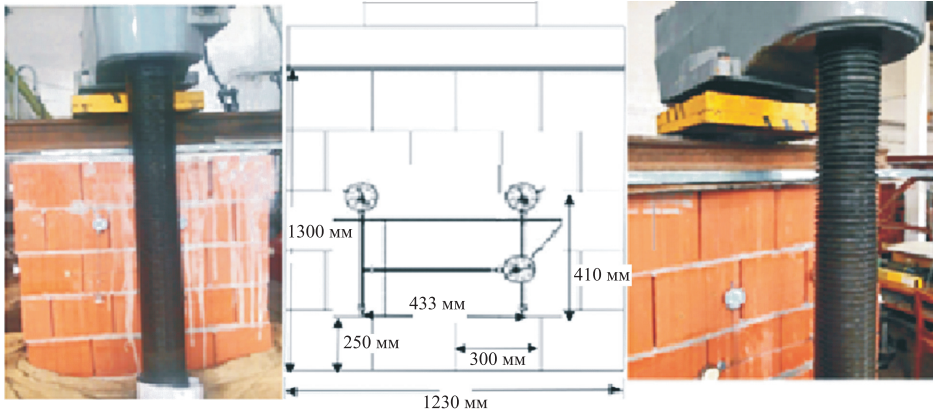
Общий вид установки для испытаний на сжатие керамической кладки, схема расположения индикаторов часового типа 2ИГ
